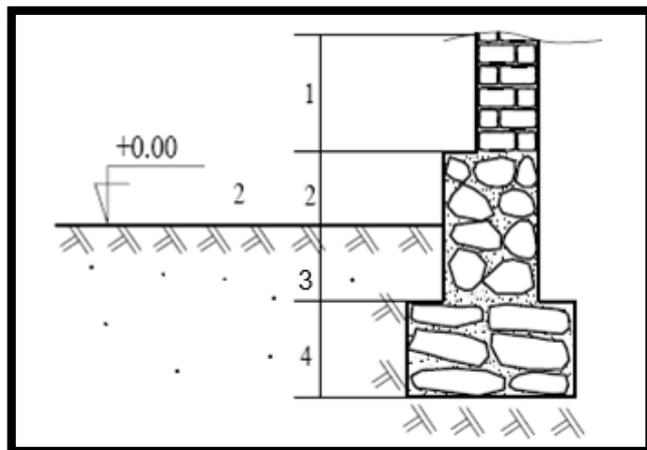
Le type de fondations utilisé dans le projet (Source : auteur)
